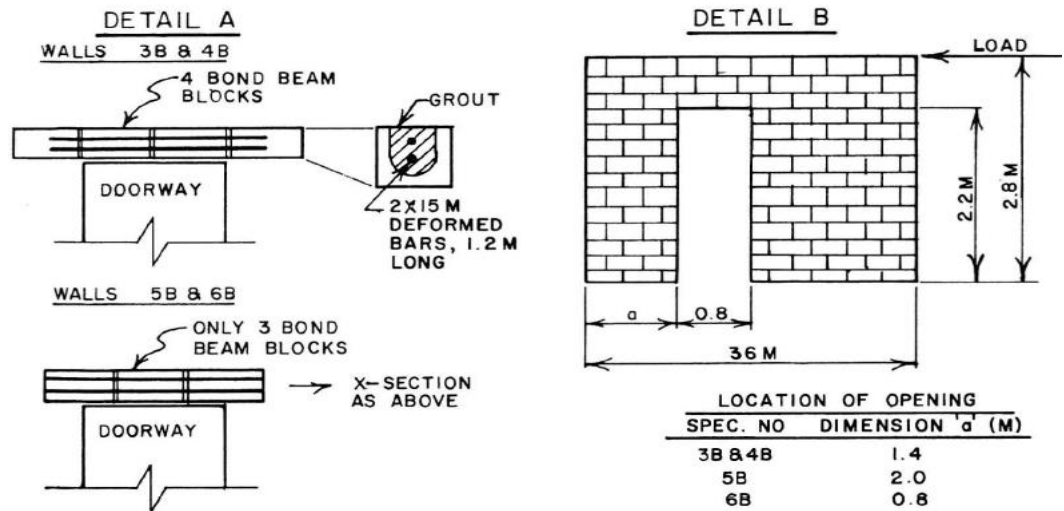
Ejemplo de mampostería reforzada Fuente: (Dawe JL, 1985)
